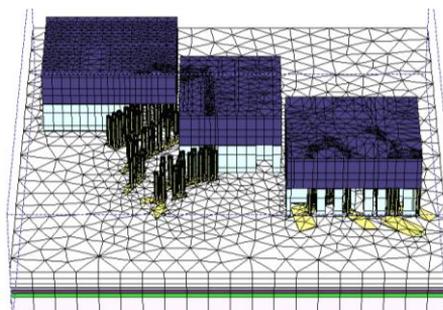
Расчетная схема (3-й этап моделирования)
